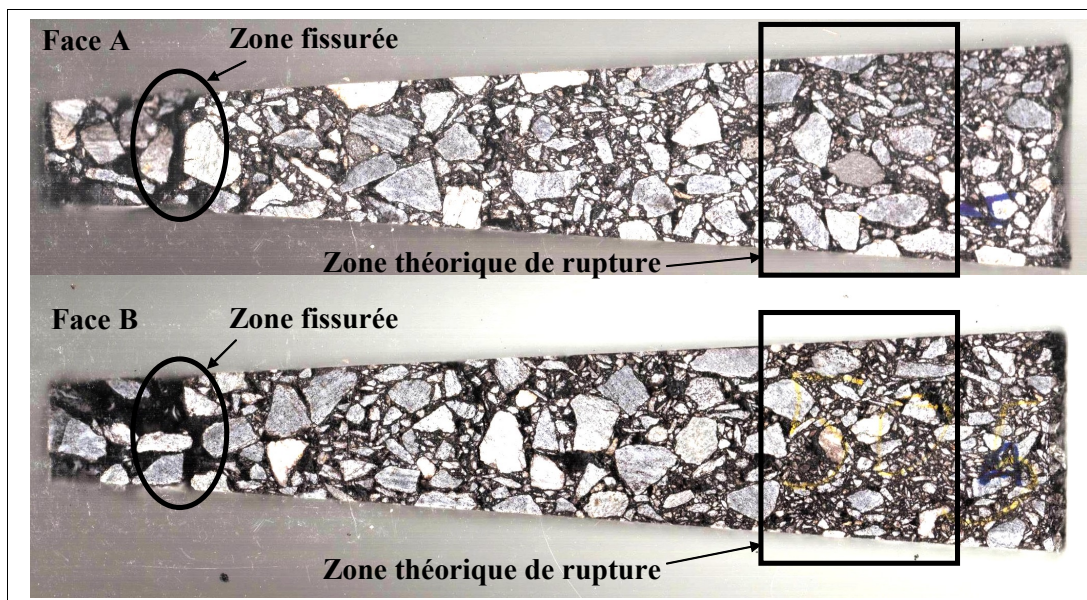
exemple d'une éprouvette fissurée en zone 5 (épreuve 3, essai 1, plan 2).
